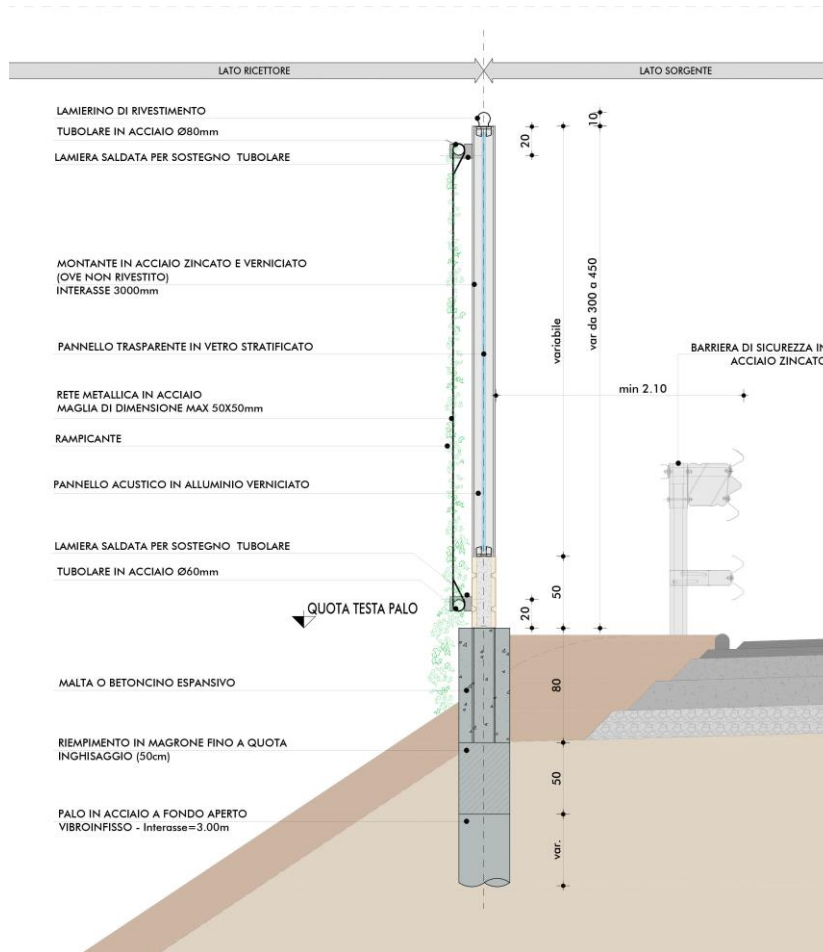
BARRIERA ACUSTICA FONOSOLANTE TRASPARENTE– SEZIONE TIPOLOGICA SU RILEVATO
